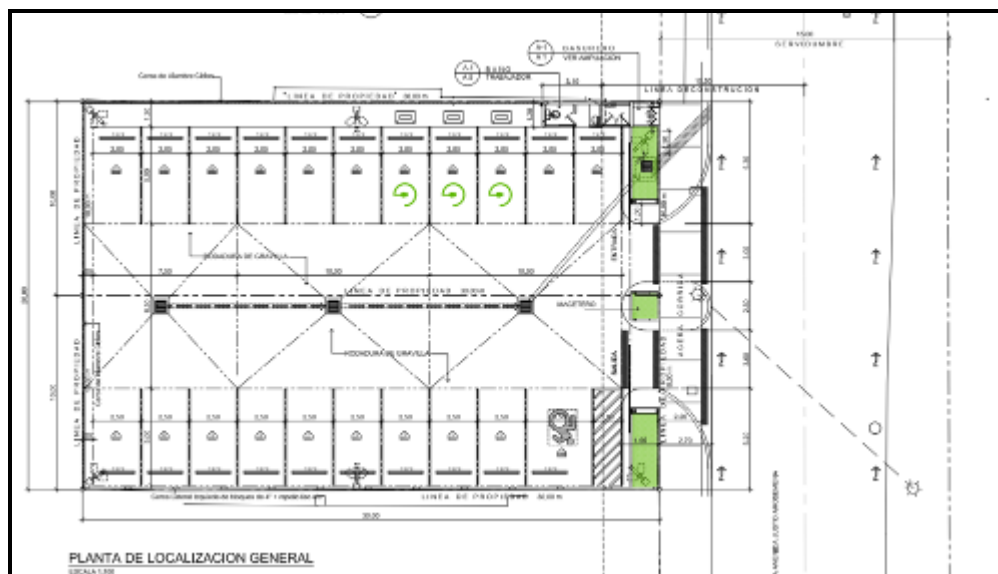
Plano del Proyecto "Estacionamientos La Exposición"
